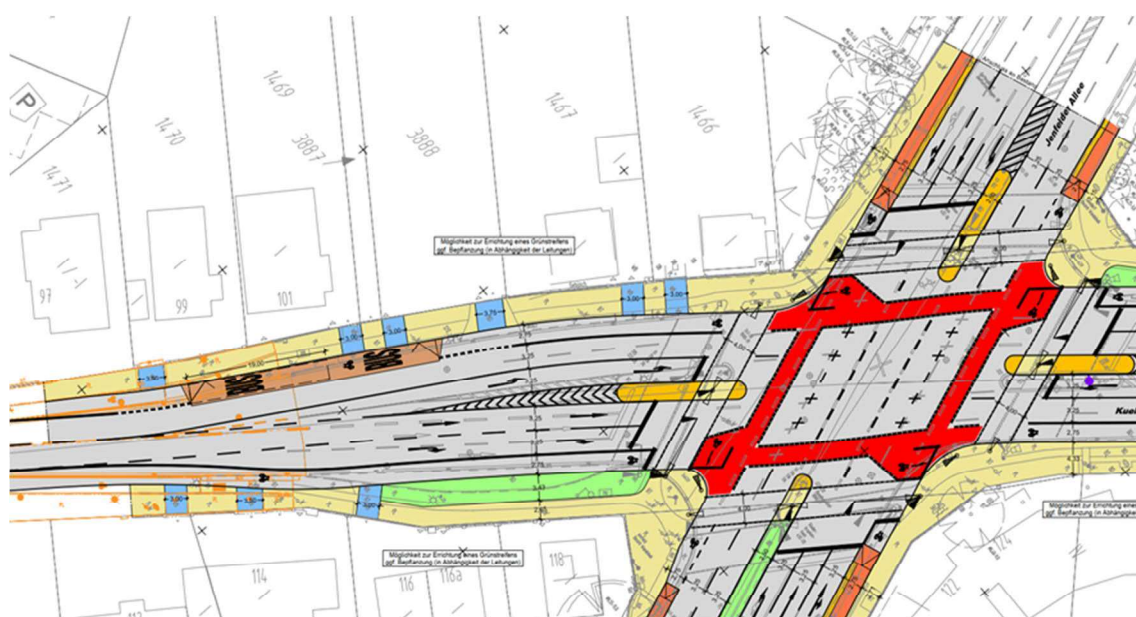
Lageplan Variante 4 (Ausschnitt)
